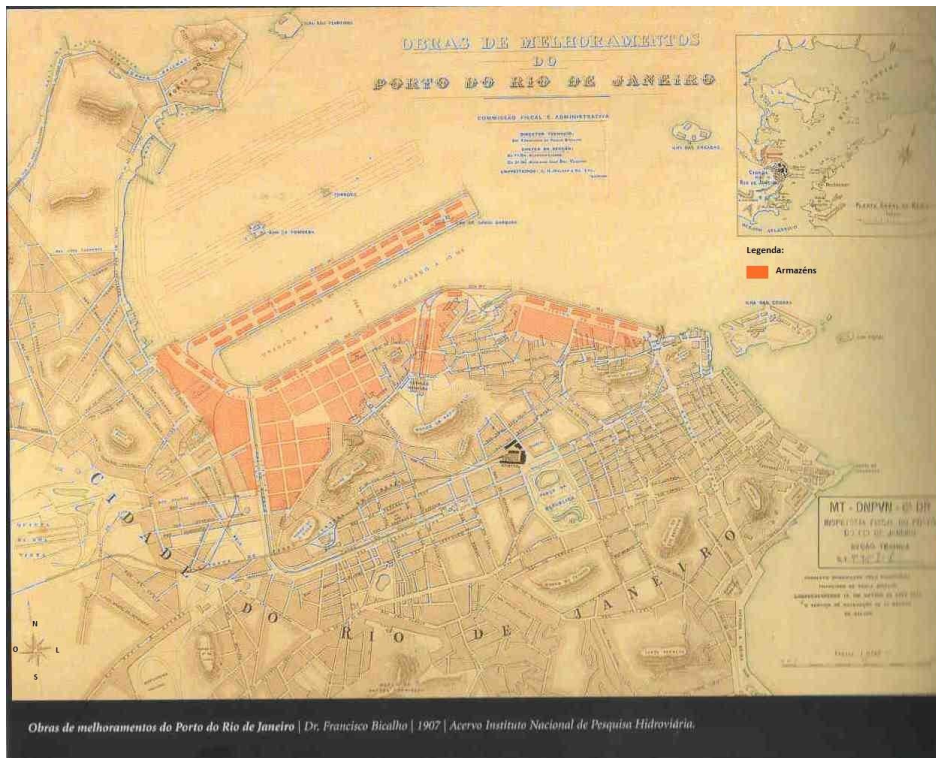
Primeira planta apresentada para as obras de melhoramento do Porto em 1907.
